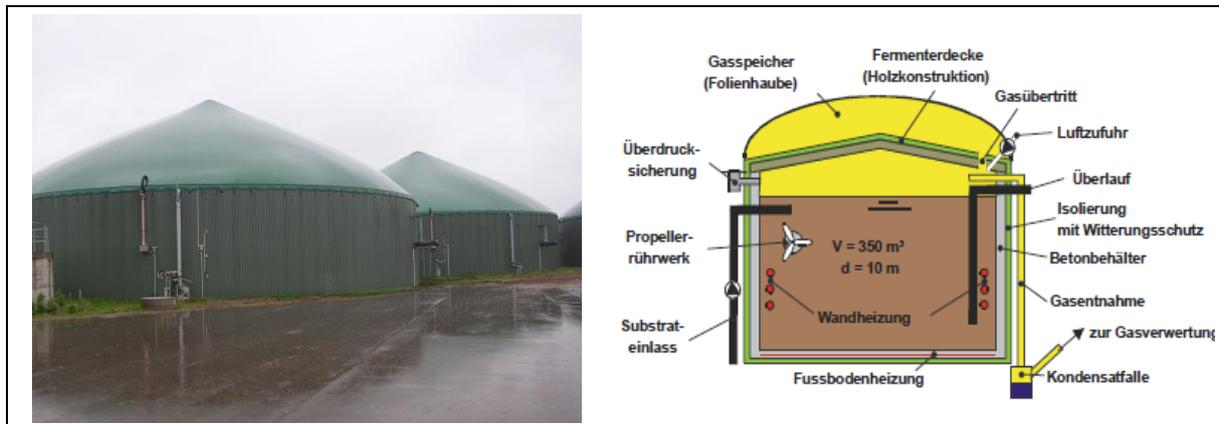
/1 und 4.3.3/2: Fermenter, stehend, runde Bauform. Fassungsvermögen des Gasspeichers: Edelstahl 10 bis 2.000 m³, Beton 100 bis über 5.000 m³ (Quelle: www.landtechnik.uni-bonn.de und Biogas-Handbuch Bayern)
